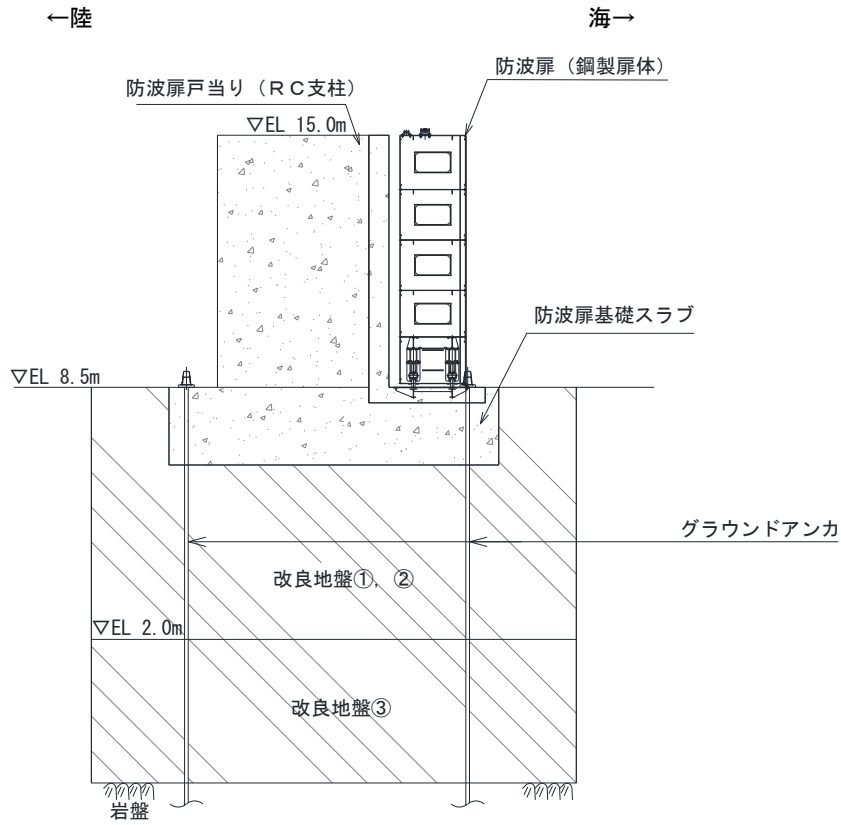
(3) 防波扉の構造図 (C-C断面)
